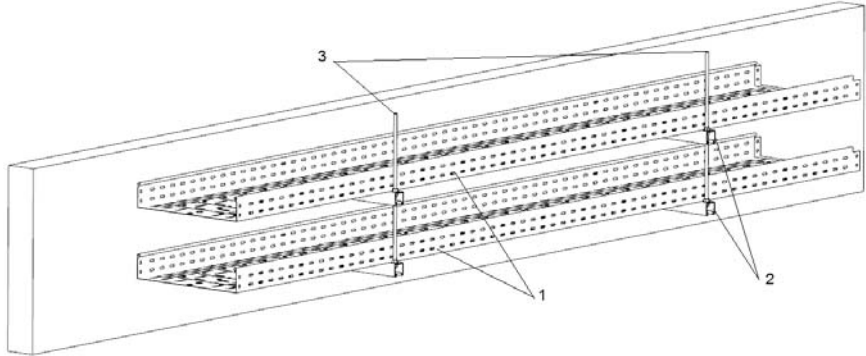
Общий вид подвеса к стене со шпилькой к потолку (таблица 42)
